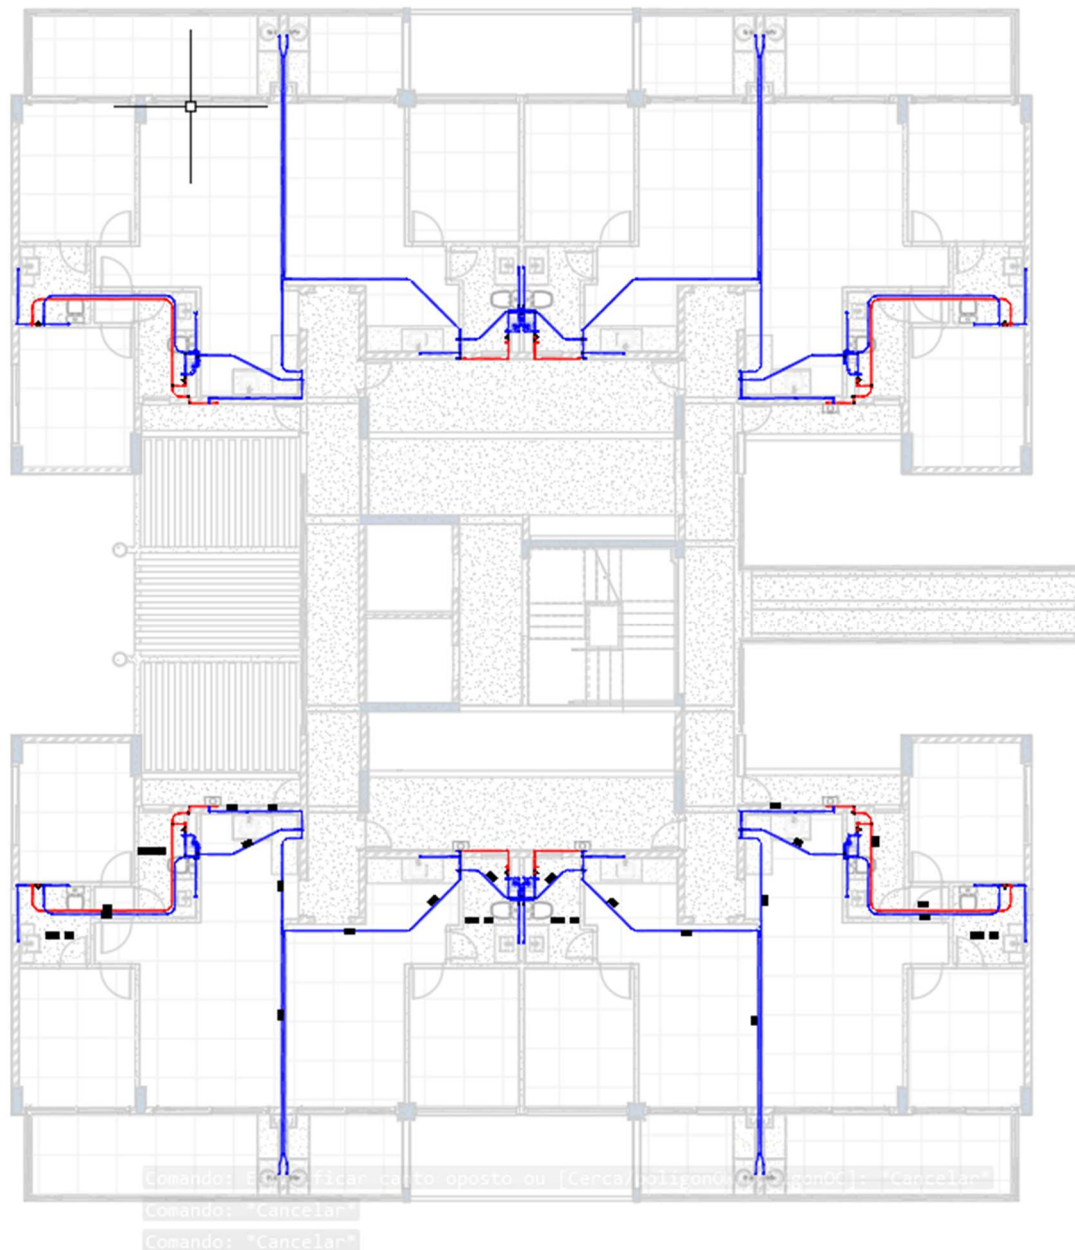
Planta baixa do ramal de água fria e quente apartamento tipo do empreendimento.
